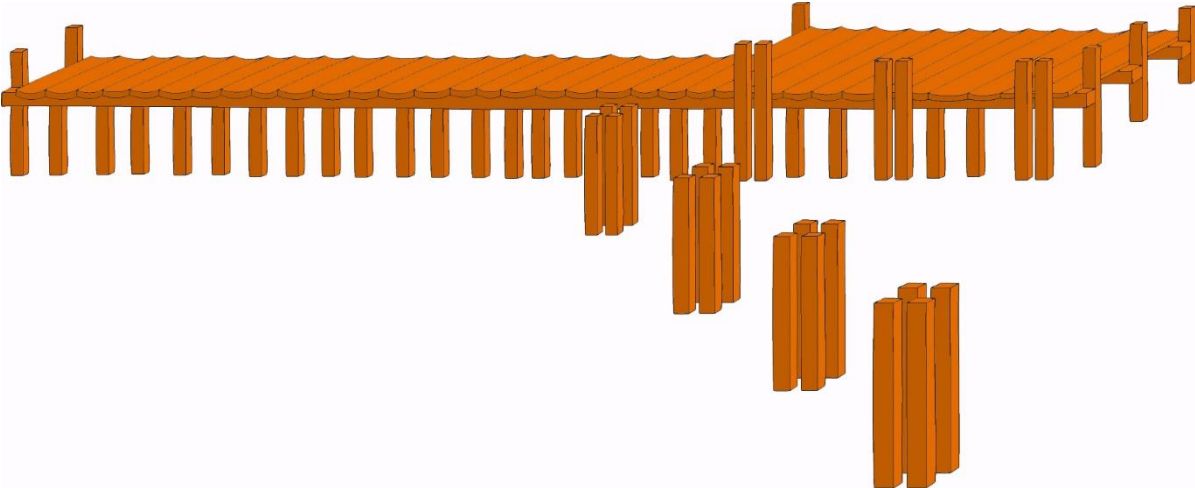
Constructie van een driedimensionale box-structuur.
